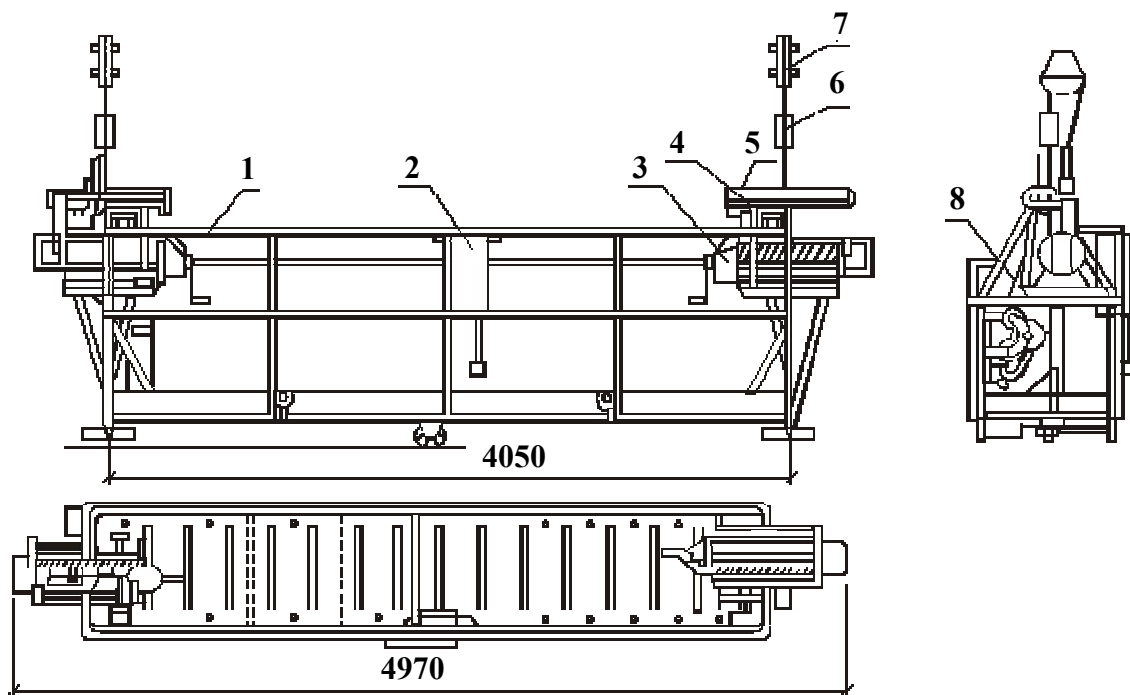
Кошика електрифікована: 1 – зварний каркас із труб; 2 – електрообладнання; 3 – лебідка; 4 – канатноведуча система; 5 – блокувальний пристрій ручного приводу; 6 – обмежувач; 7 – підвіска люльки до консолей; 8 – канат запобіжний
